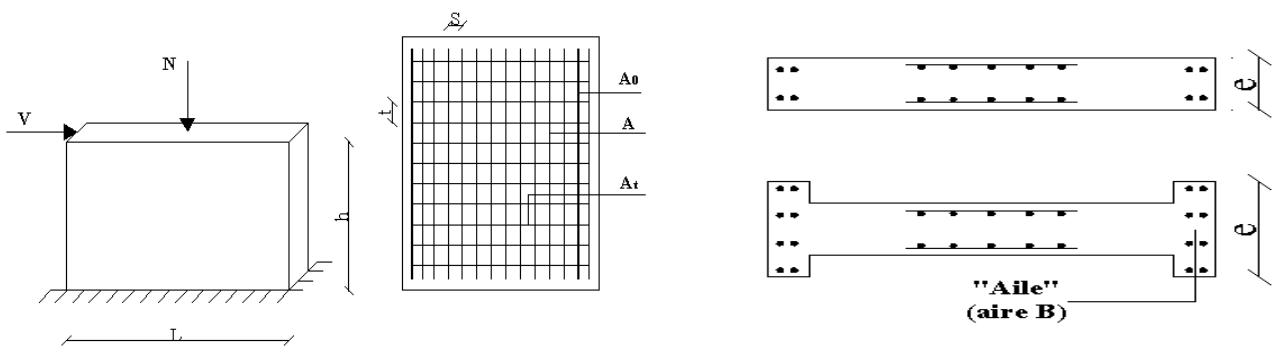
Schéma d'un voile plein et disposition du ferrailage.
